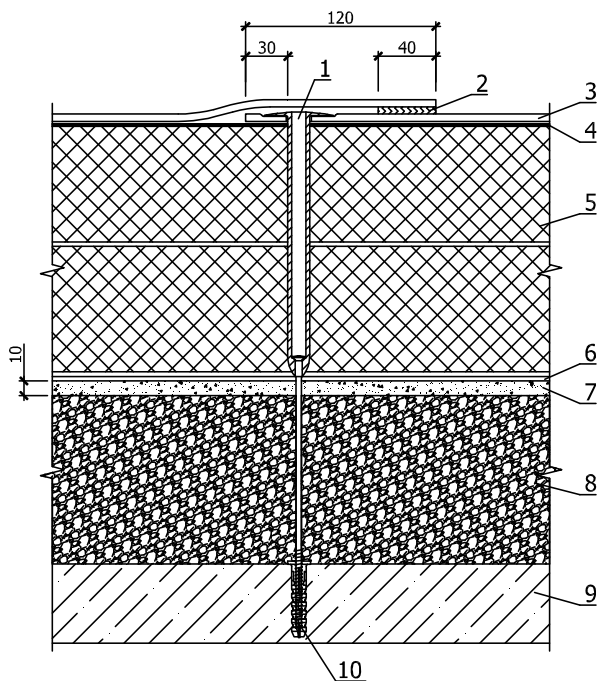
Механическое крепление мембраны к бетонному основанию покрытия:
